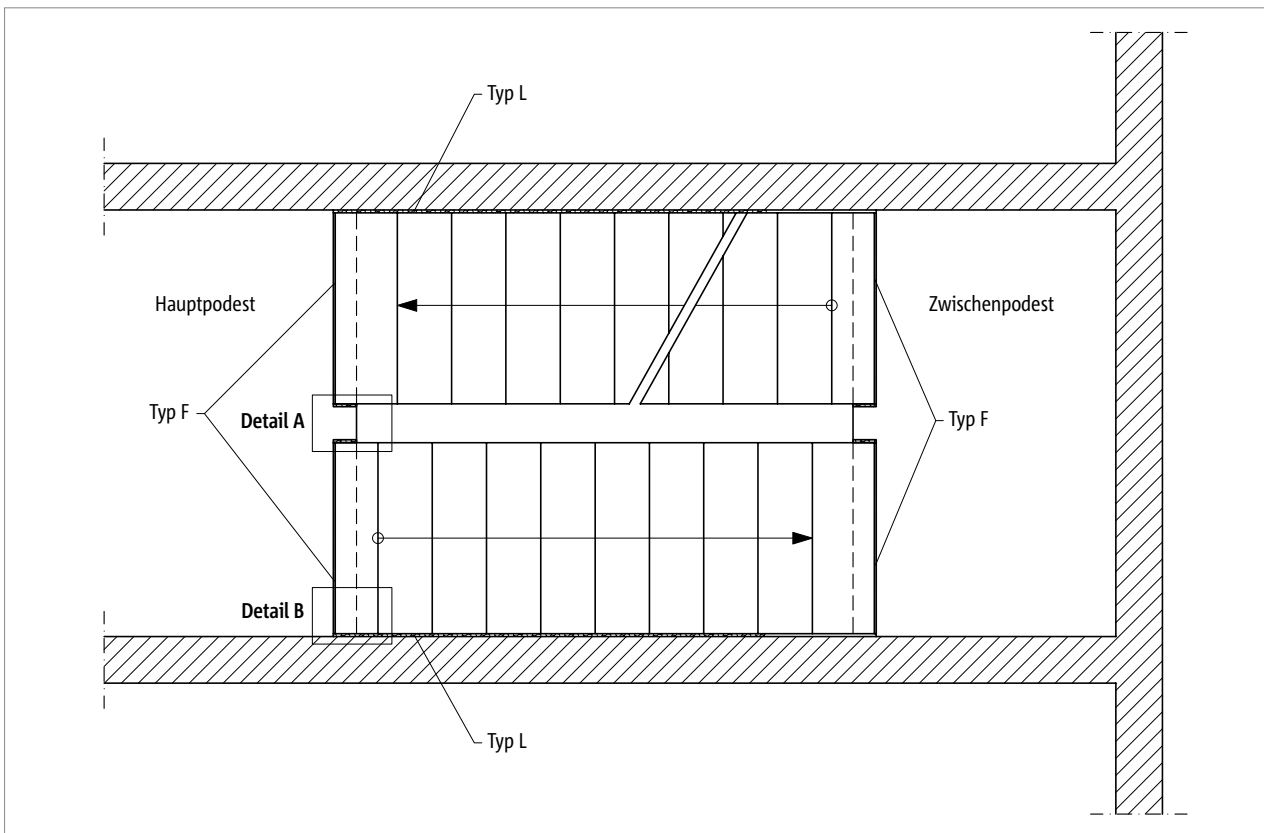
Schöck Tronsole® Typ F: Elementanordnung im Grundriss
